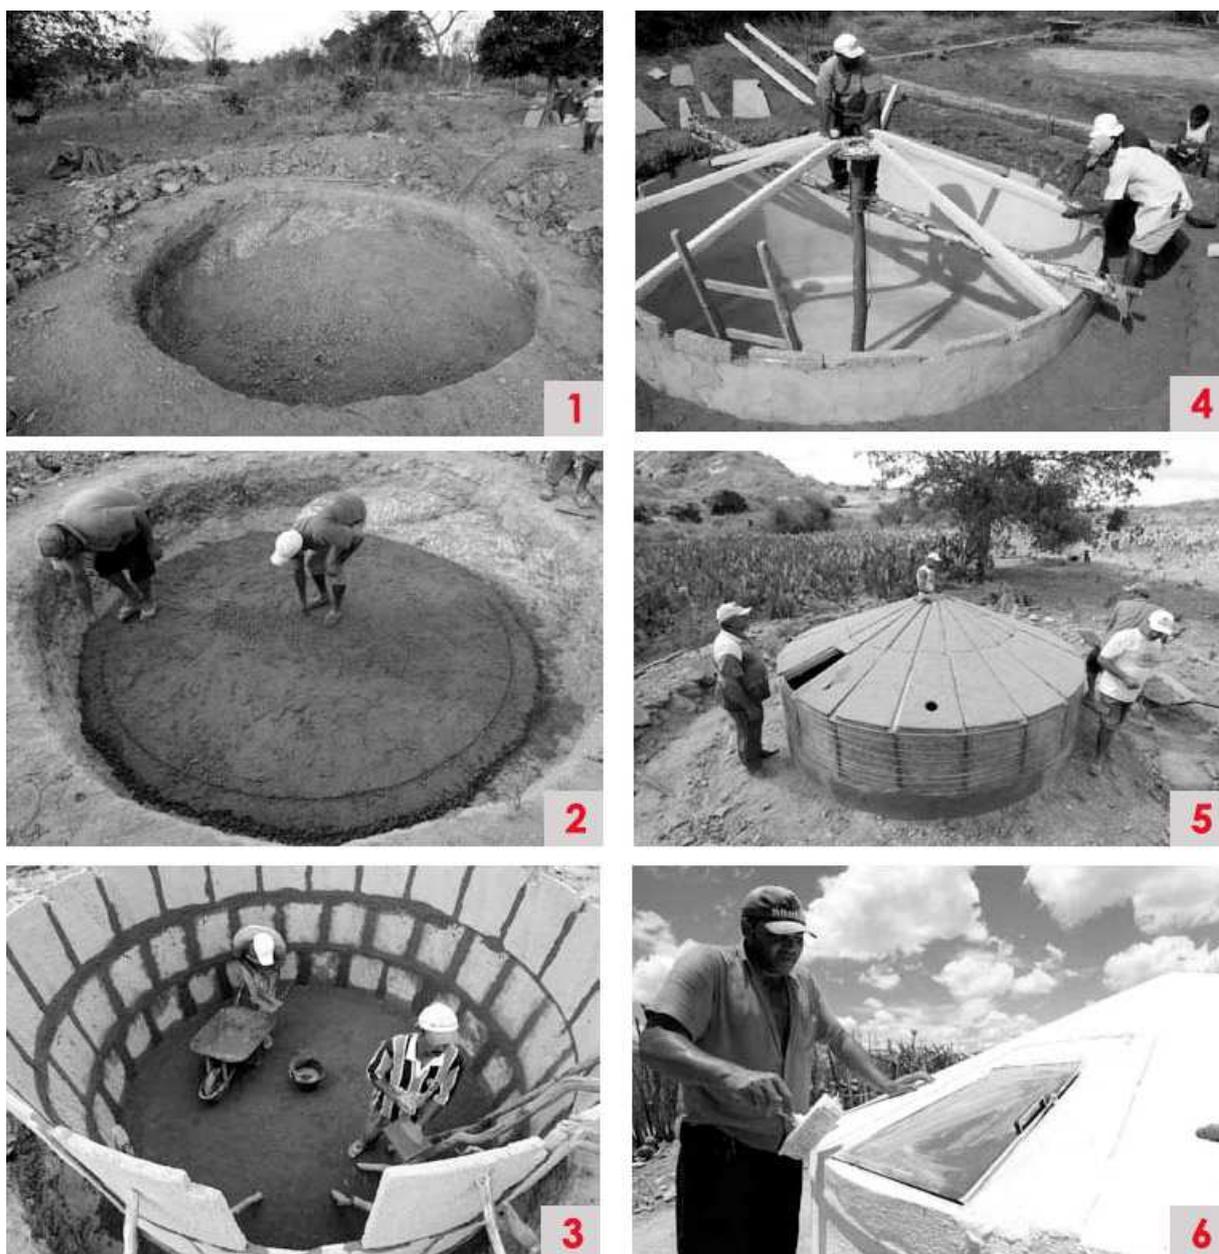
h: Etapas da construção de cisterna moldada in loco.
